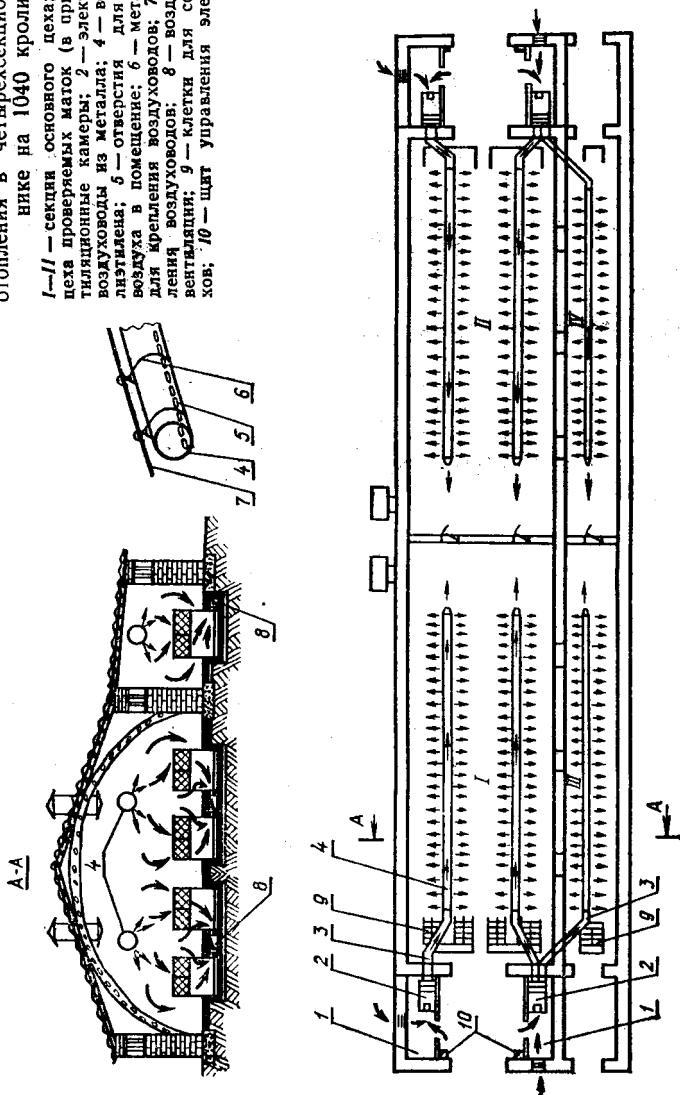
Схема воздухопроводов воздушного отопления в четырехсекционном крольчатнике на 1040 кролико-мест:
